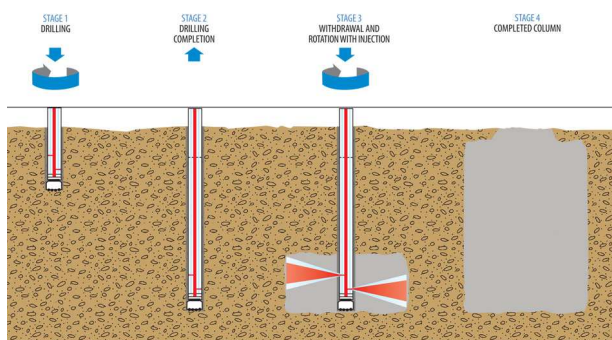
Consolidazione del sottosuolo tramite realizzazione di jet-grouting
